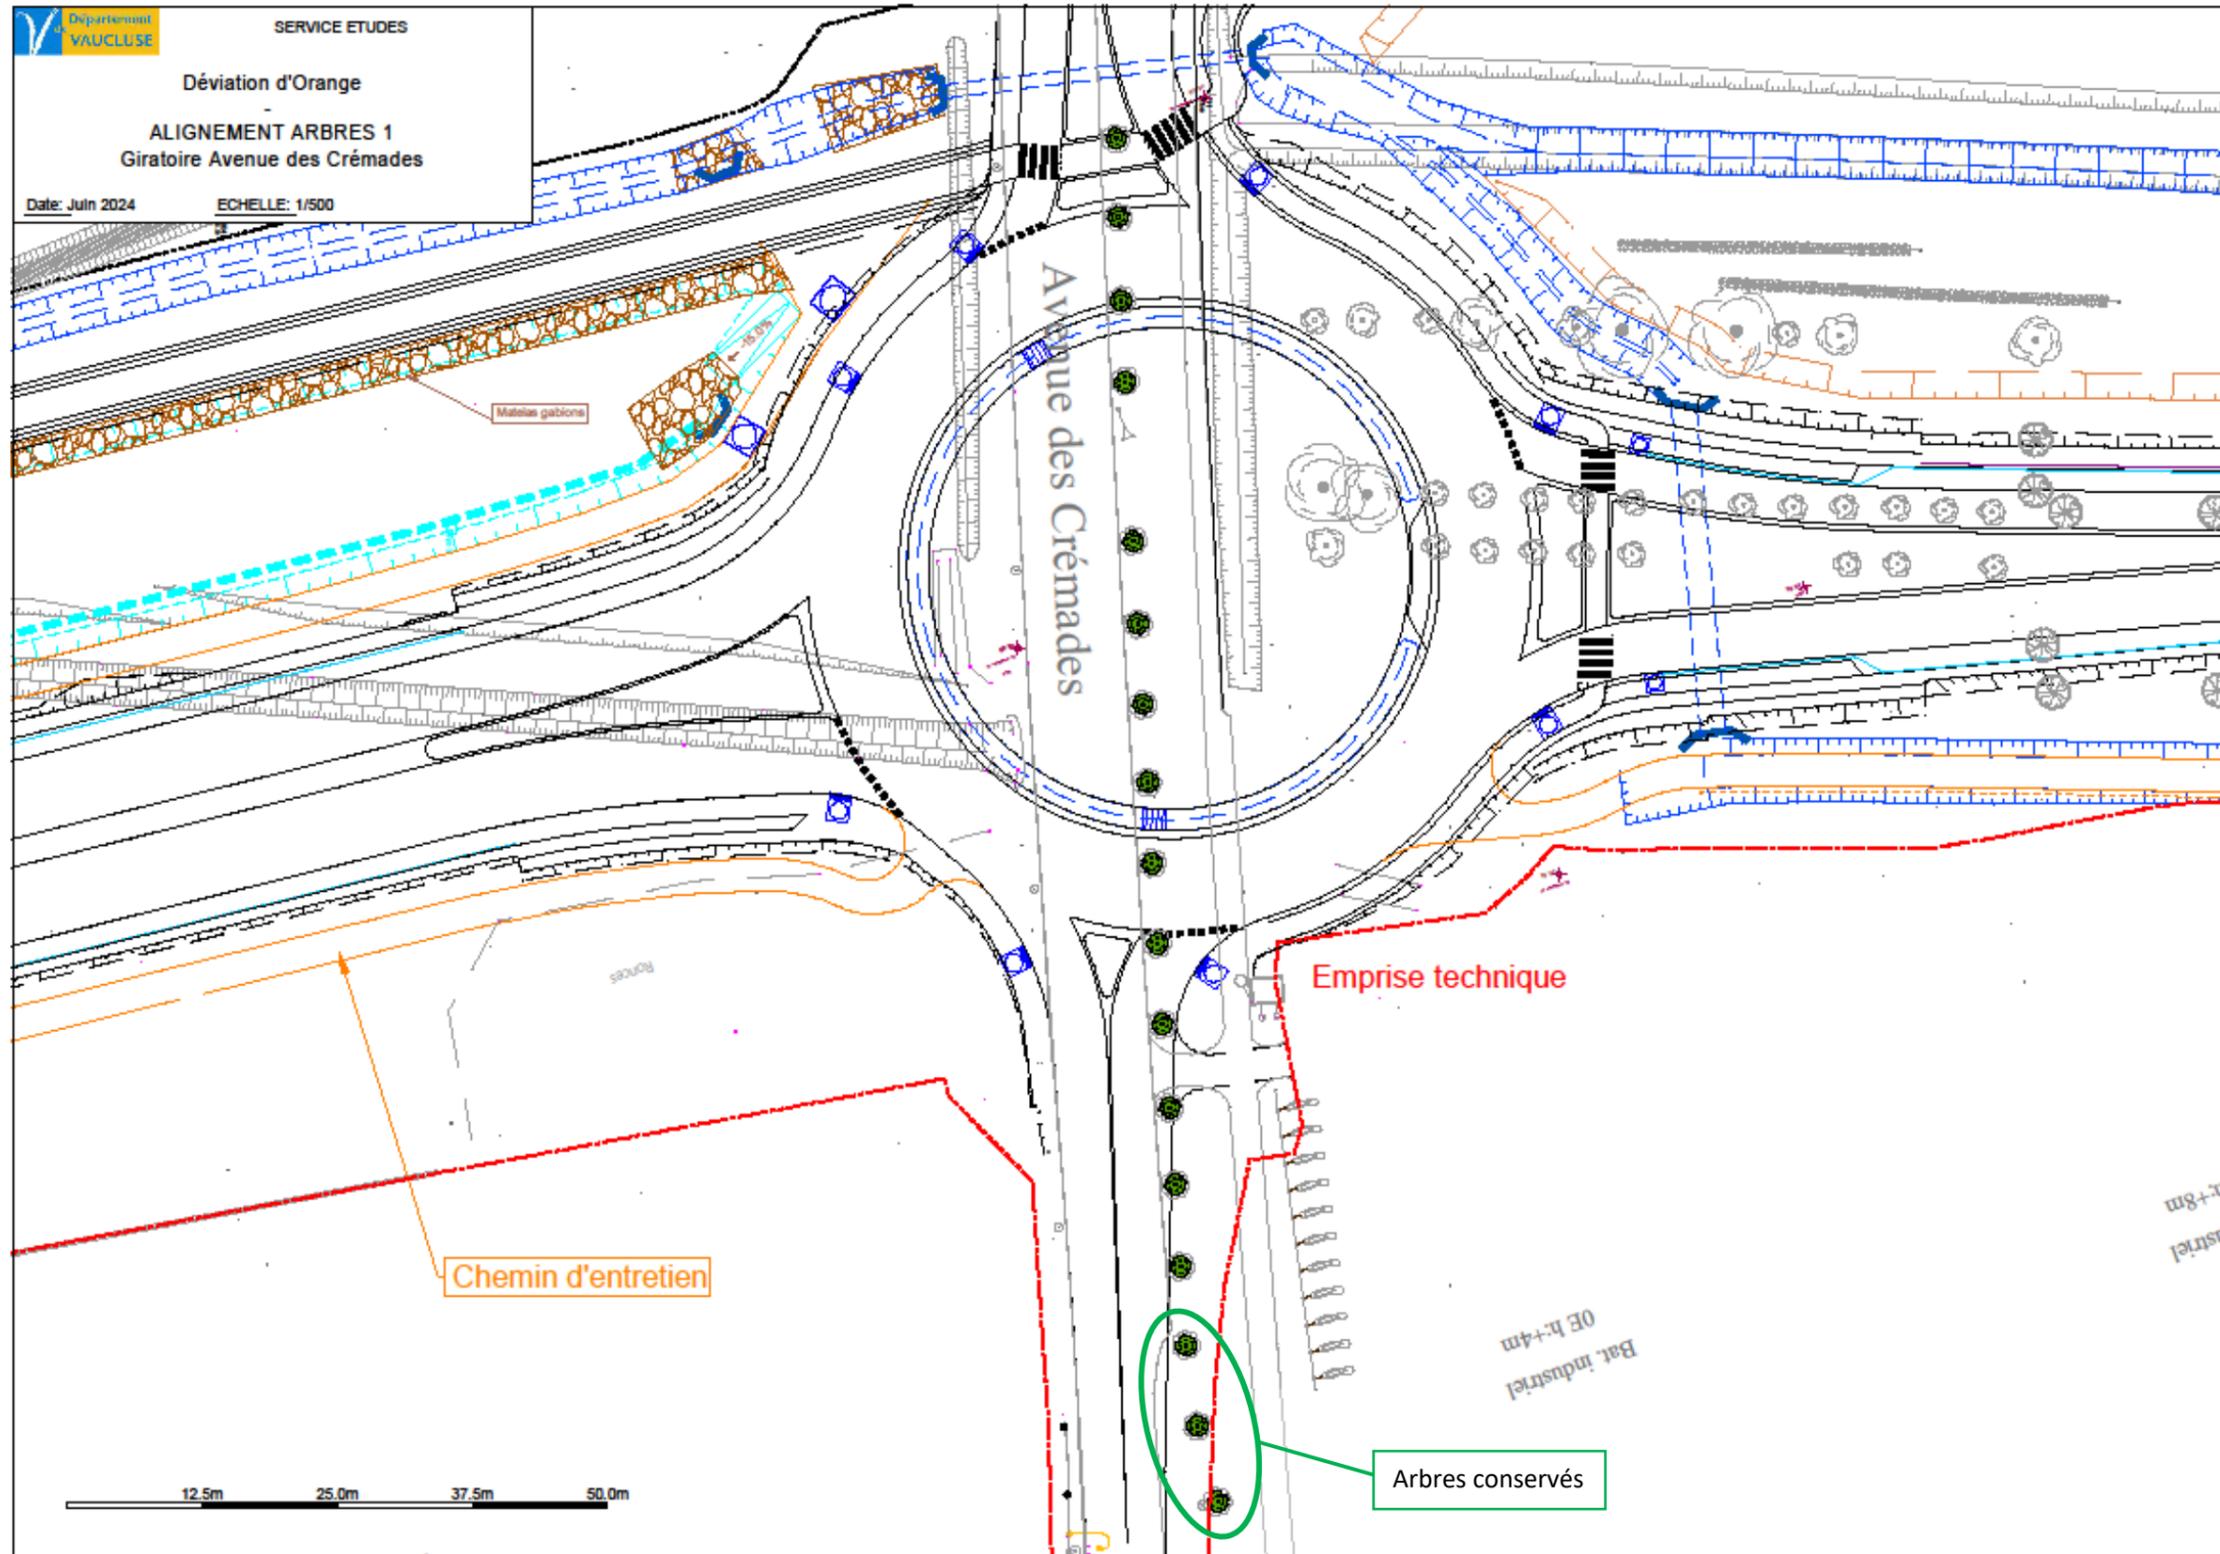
Plan du giratoire de l'Avenue des Crémades - alignement 1 (CD84)
